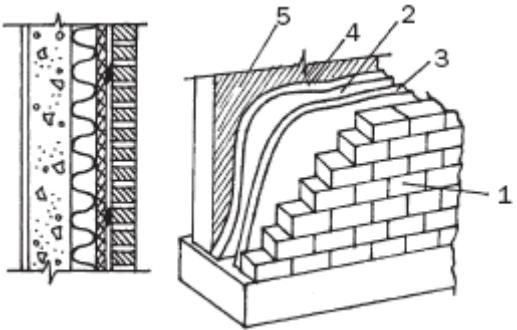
Многослойная система: 1 – наружная облицовка; 2 – вентиляционный зазор; 3 – ветрозащита; 4 – теплоизоляция; 5 – несущая стена
